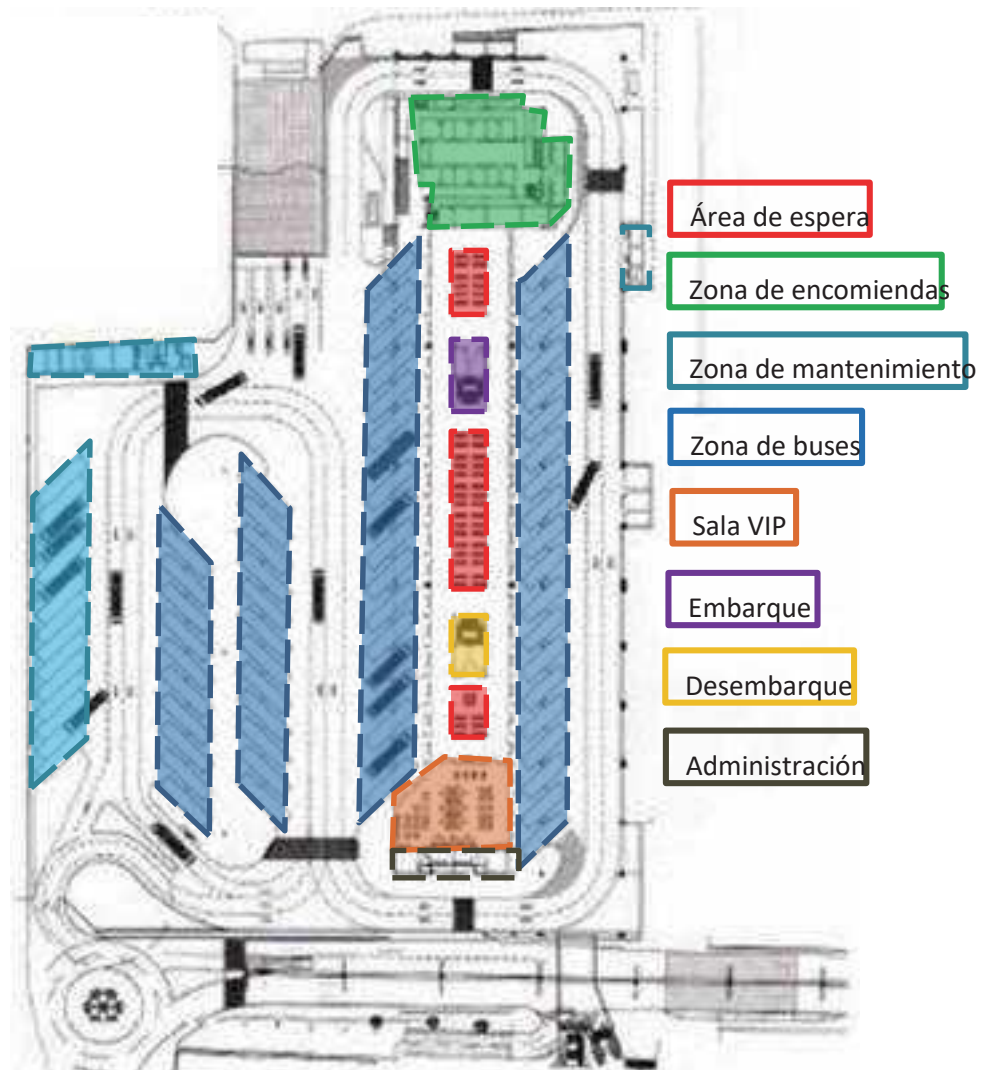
Primera Planta - Terminal Terrestre Plaza Lima Norte.
